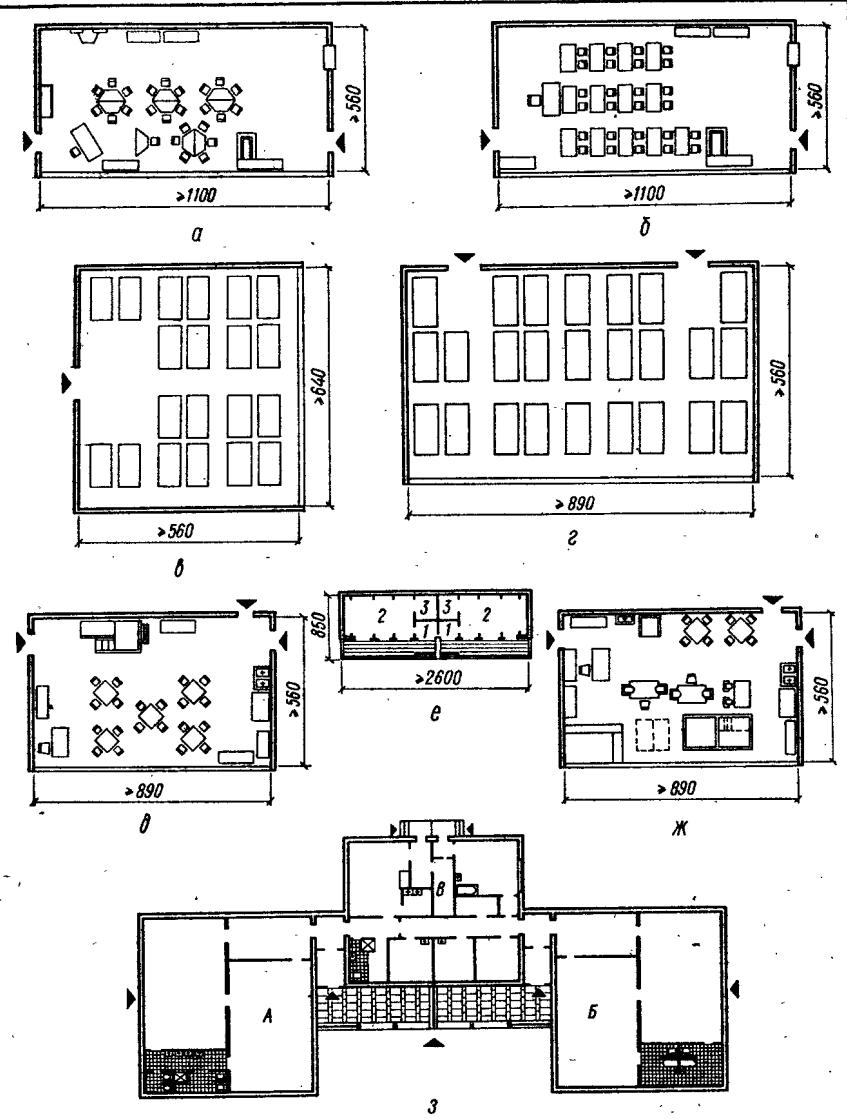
Элементы планировки помещений ясельной и дошкольной групп:
